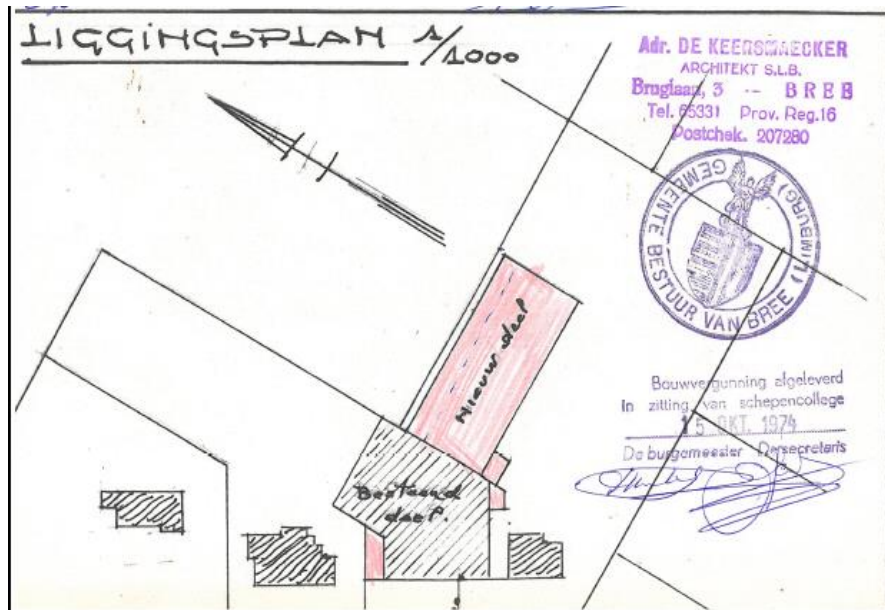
vergunning wijziging parking LAG, bron Stad Bree
